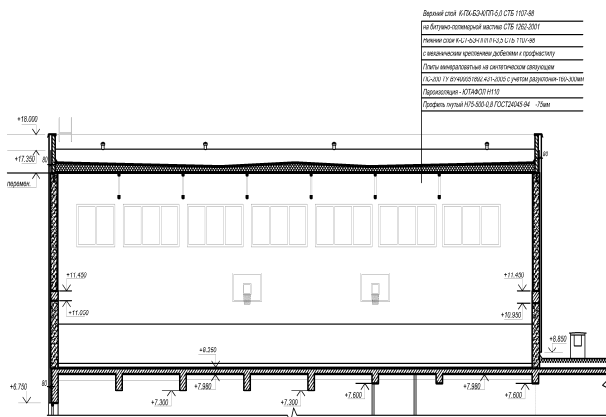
Несущие конструкции покрытия фермы из ГСП
